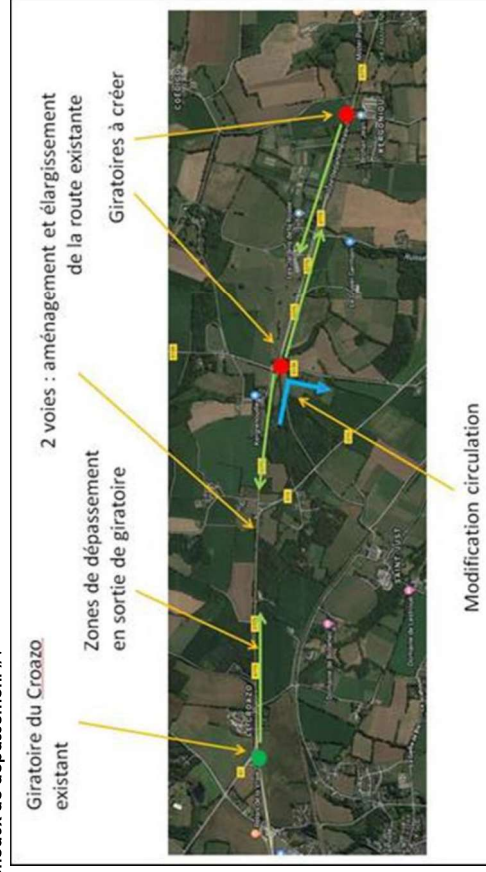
Extrait de la proposition d'un collectif (bidirectionnelle avec créneaux de dépassement) (source : CD56)
